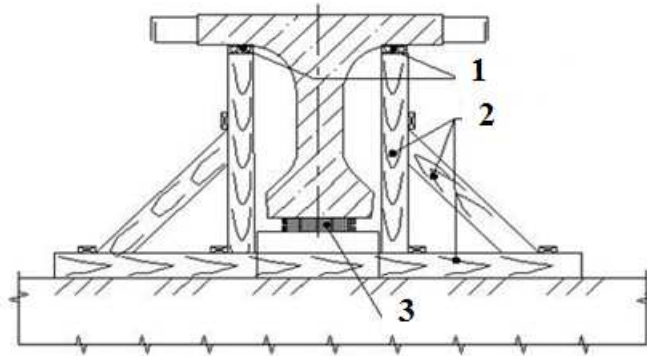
Схема обеспечения устойчивого вертикального положения балки при их монтаже
